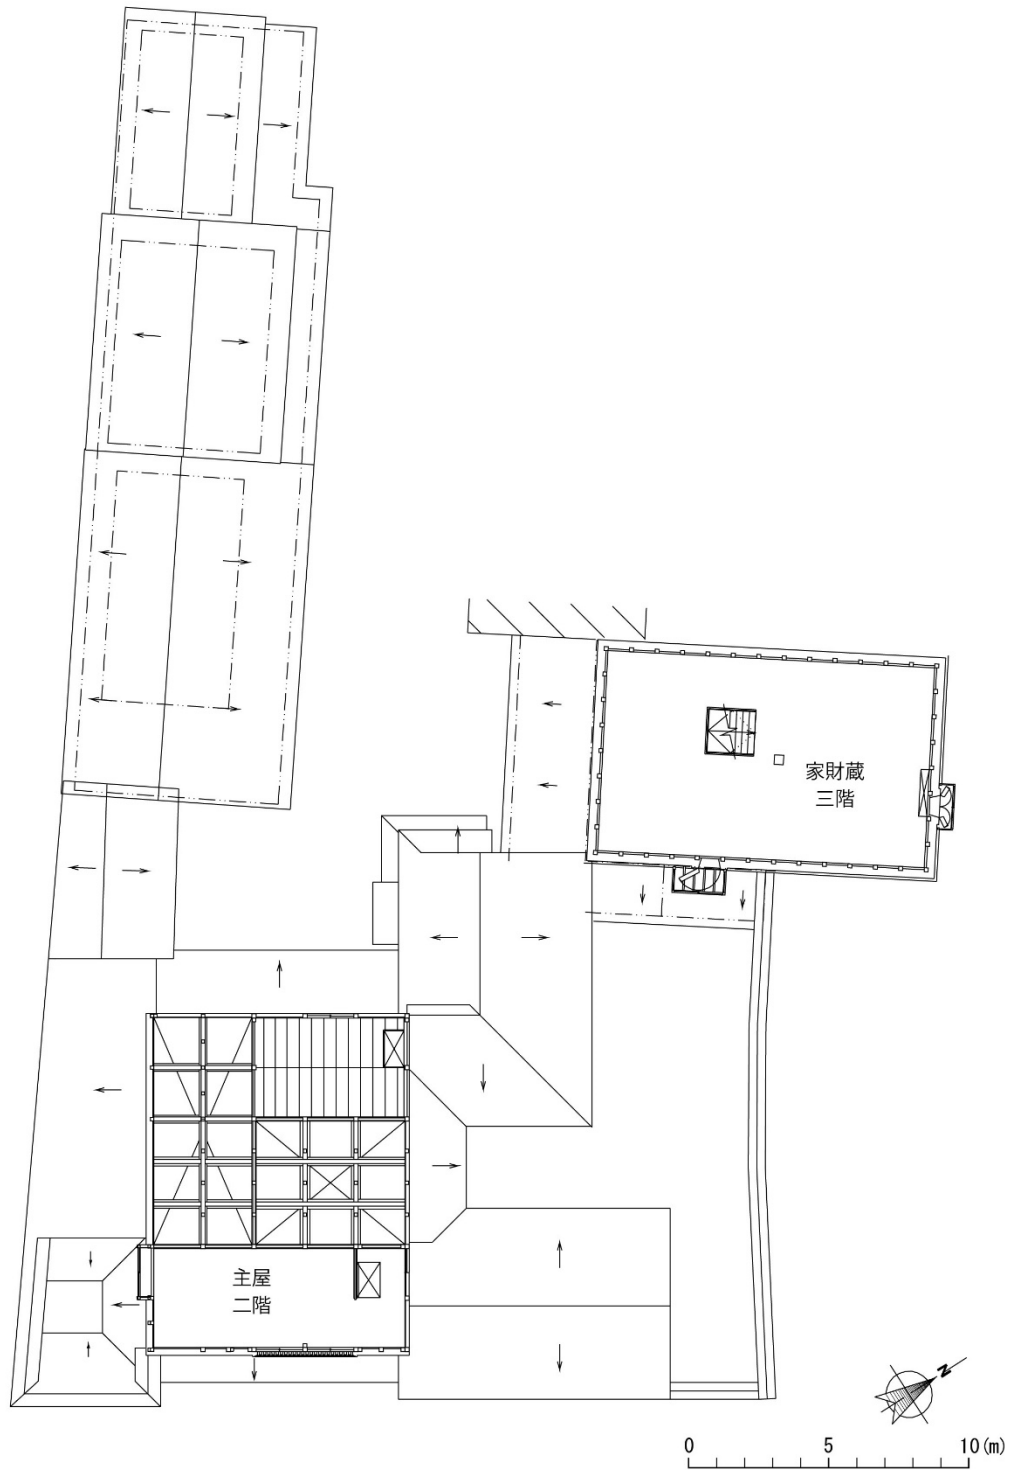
旧角海家住宅 平面図（主屋二階、家財蔵三階）
